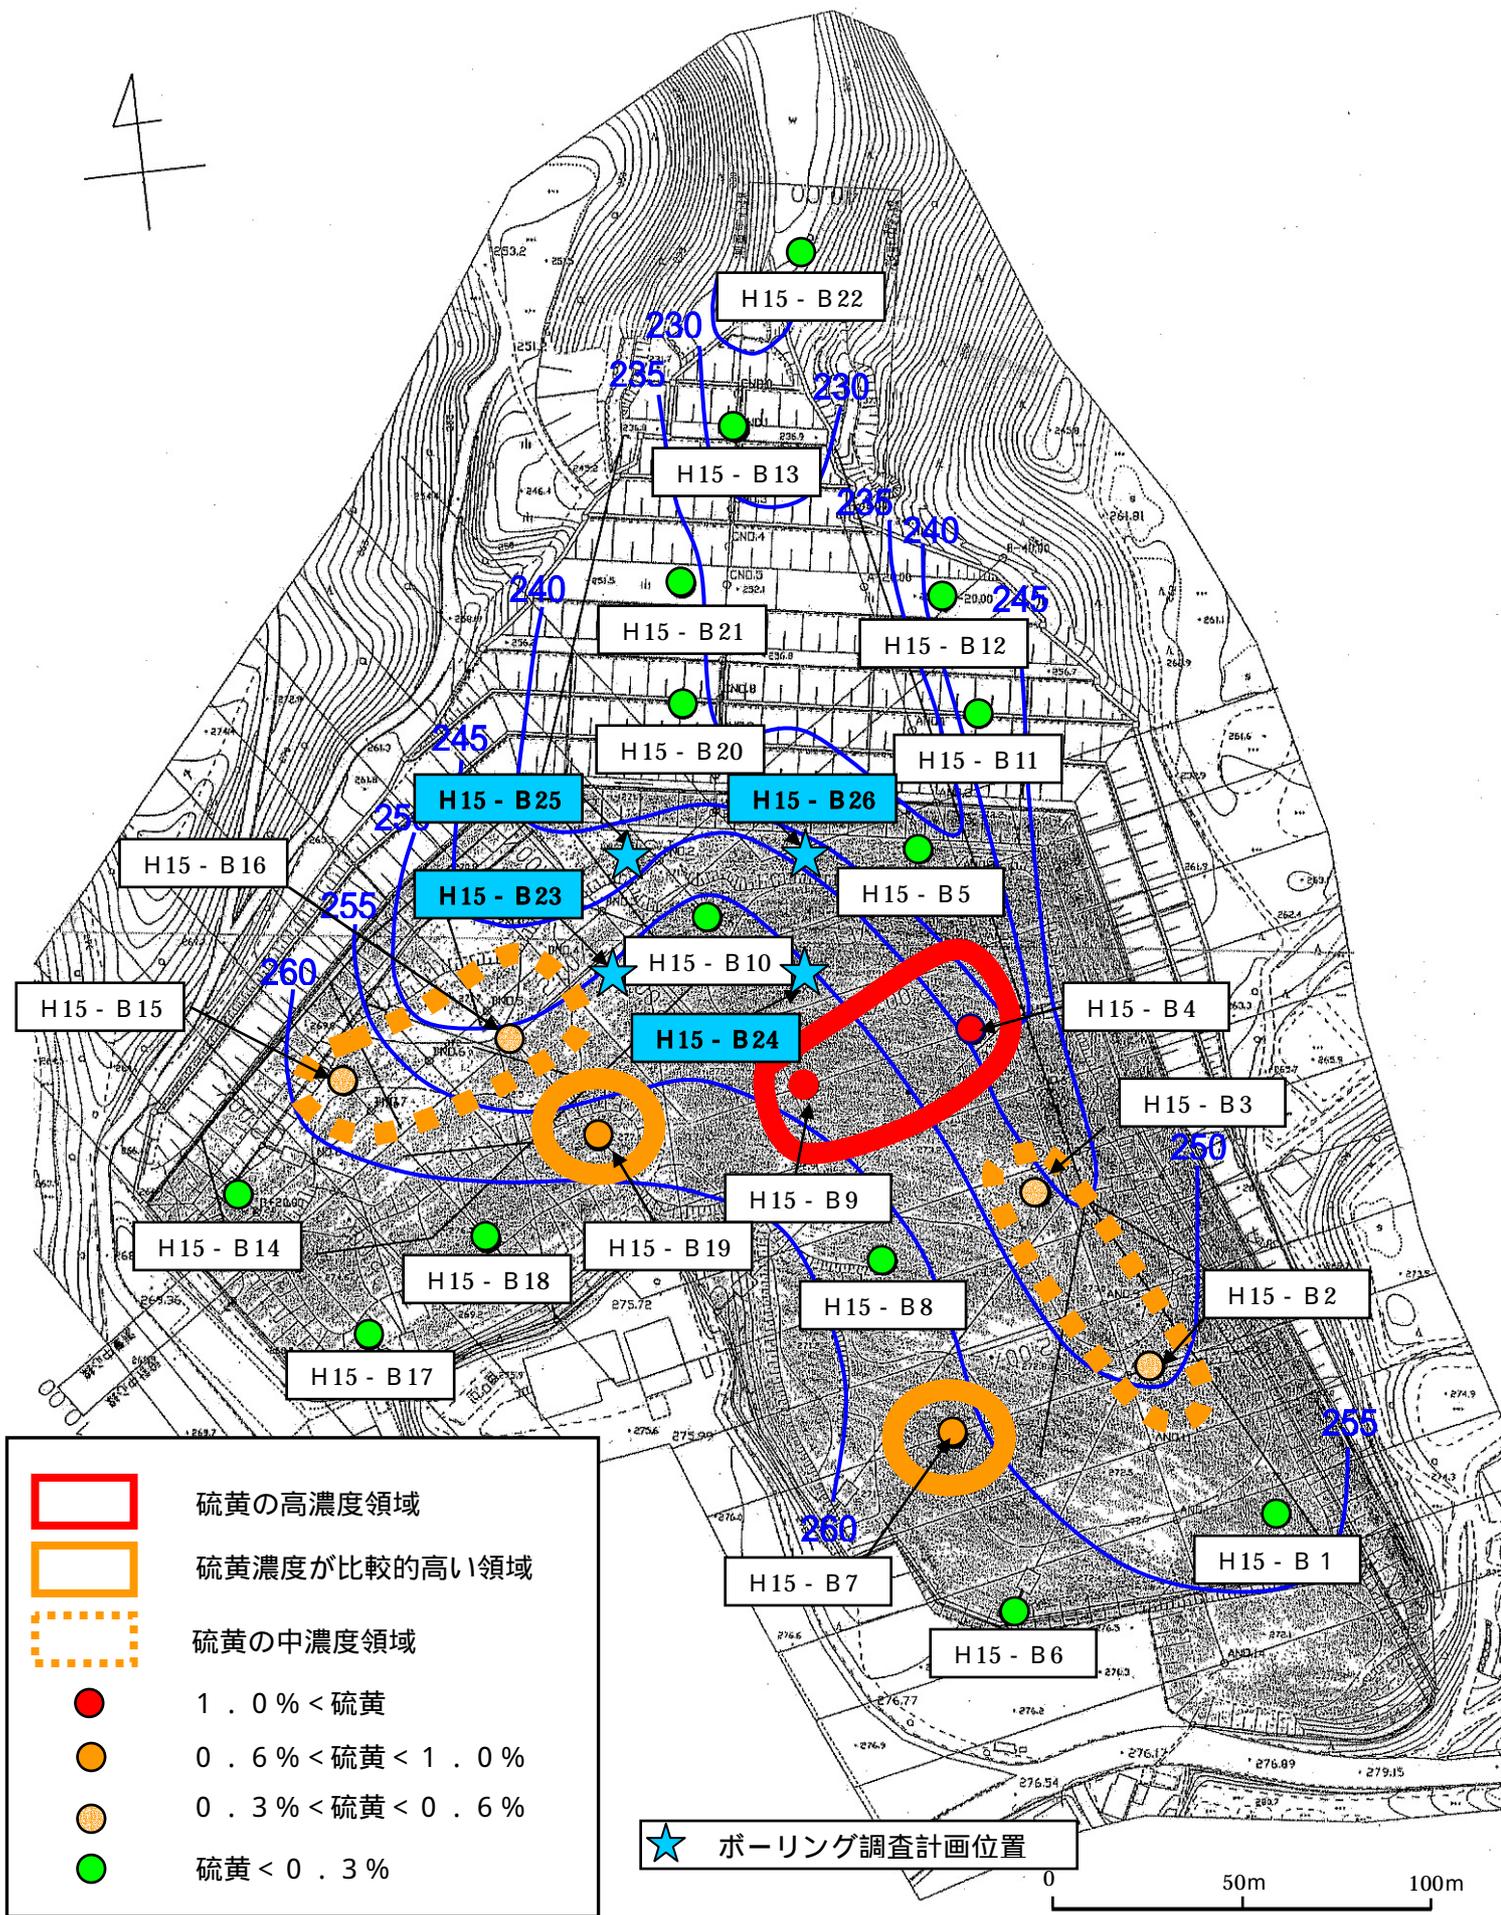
ボーリング調査計画位置平面図 (縮尺 s = 1/2,000)
